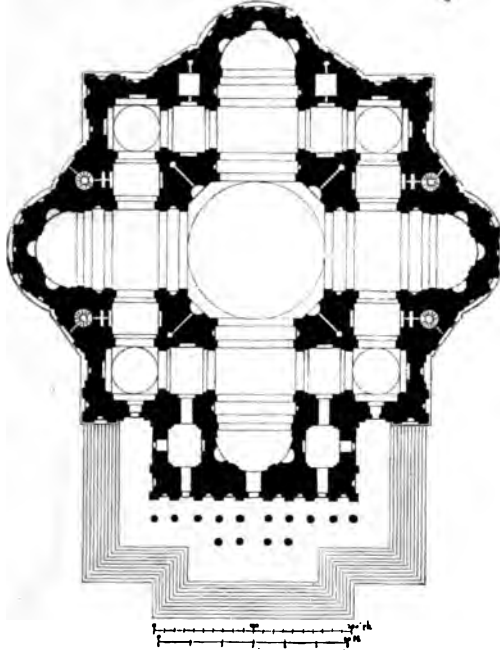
St. Peter. Michelangelos Grundriss.
